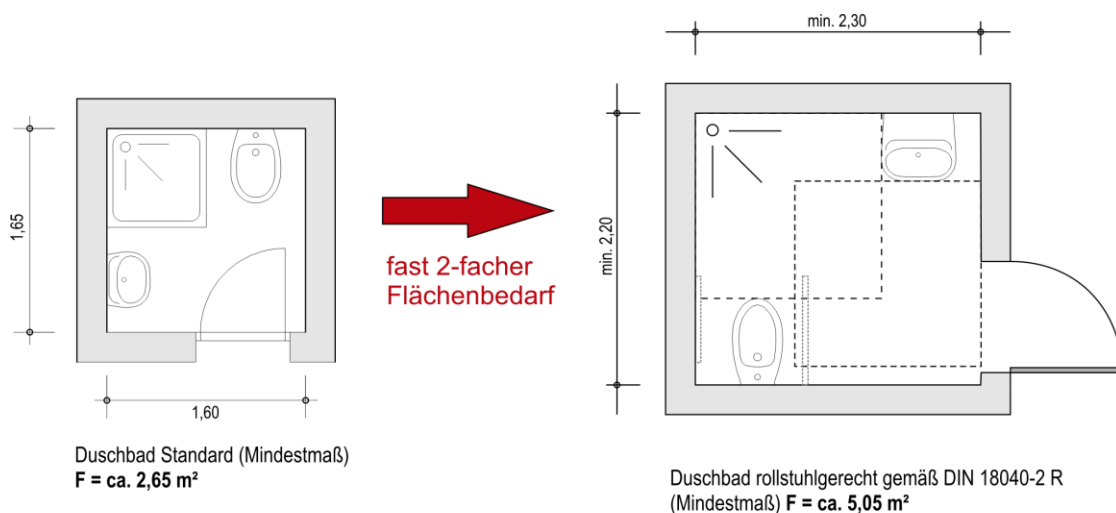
Flächenvergleich Mehrflächen Standard-Bad zu rollstuhlgerechtem Bad
